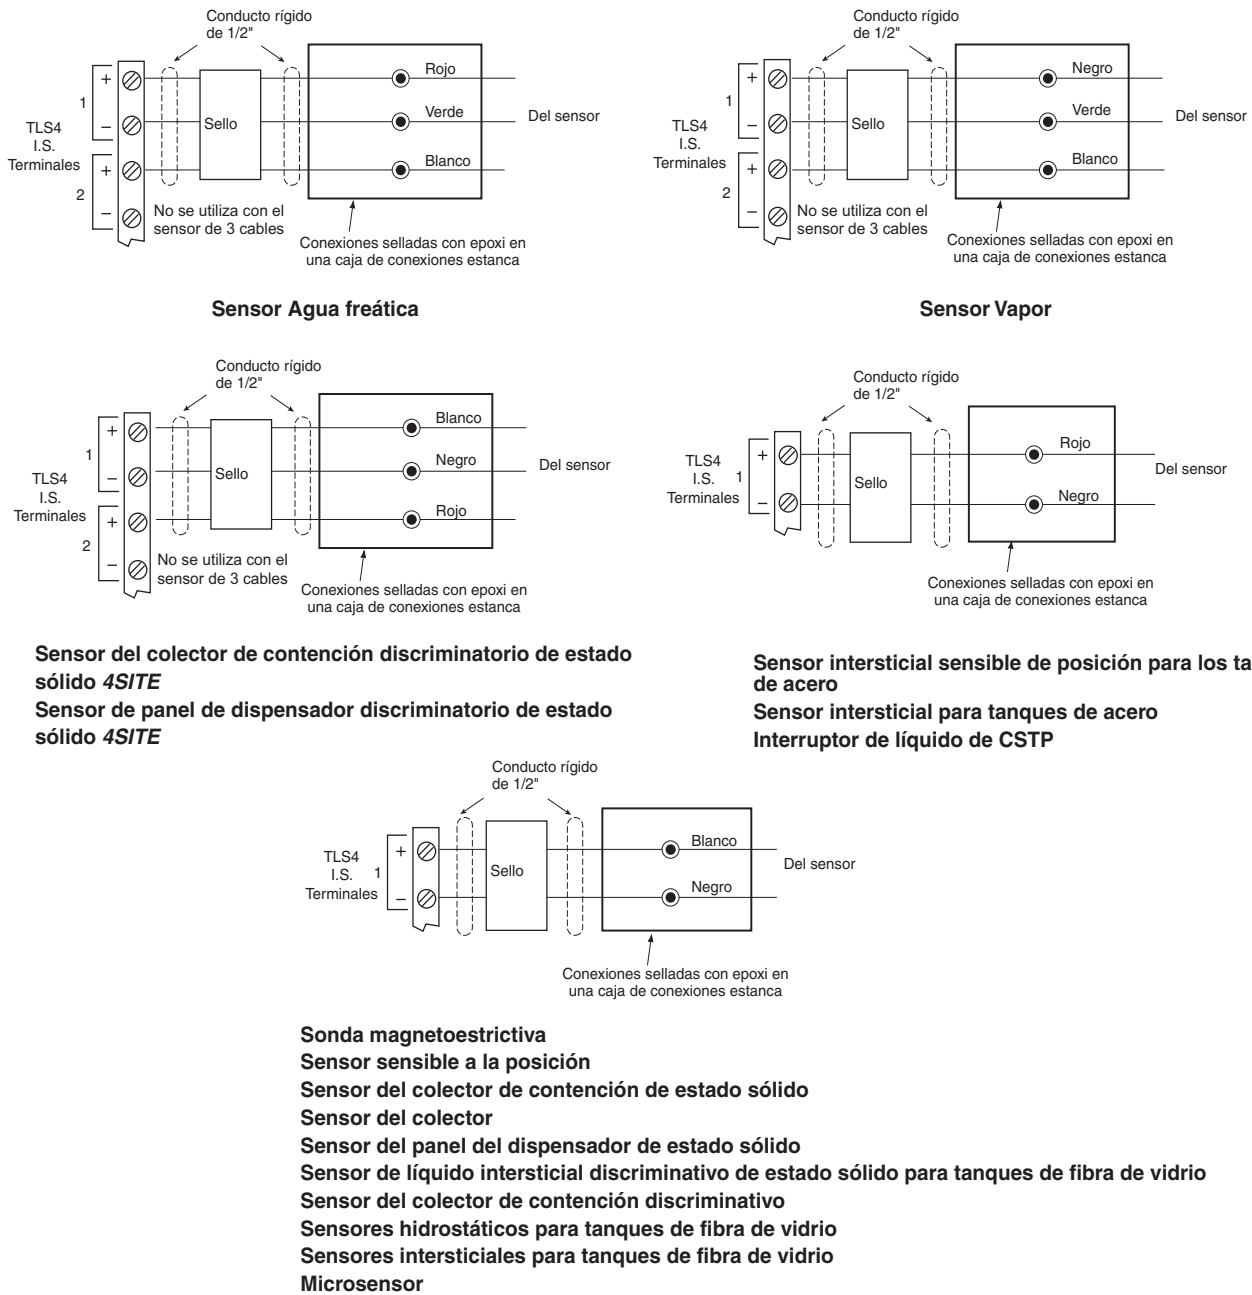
Cables del sensor y sonda de cableado de campo a los cables de la consola
